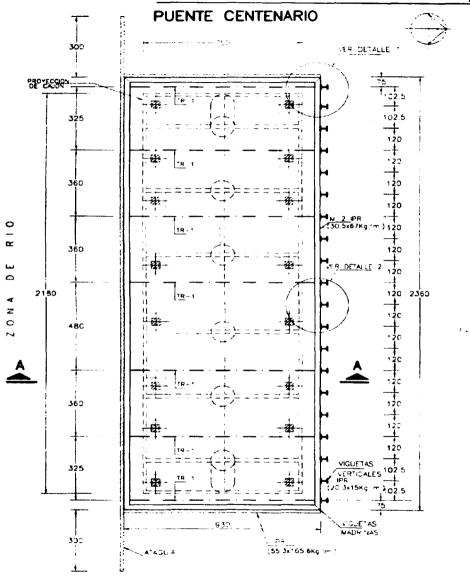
29 DETALLES DEL TROQUELAMIENTO DEL CAJON TIPO I ADYACENTE AL RIO
